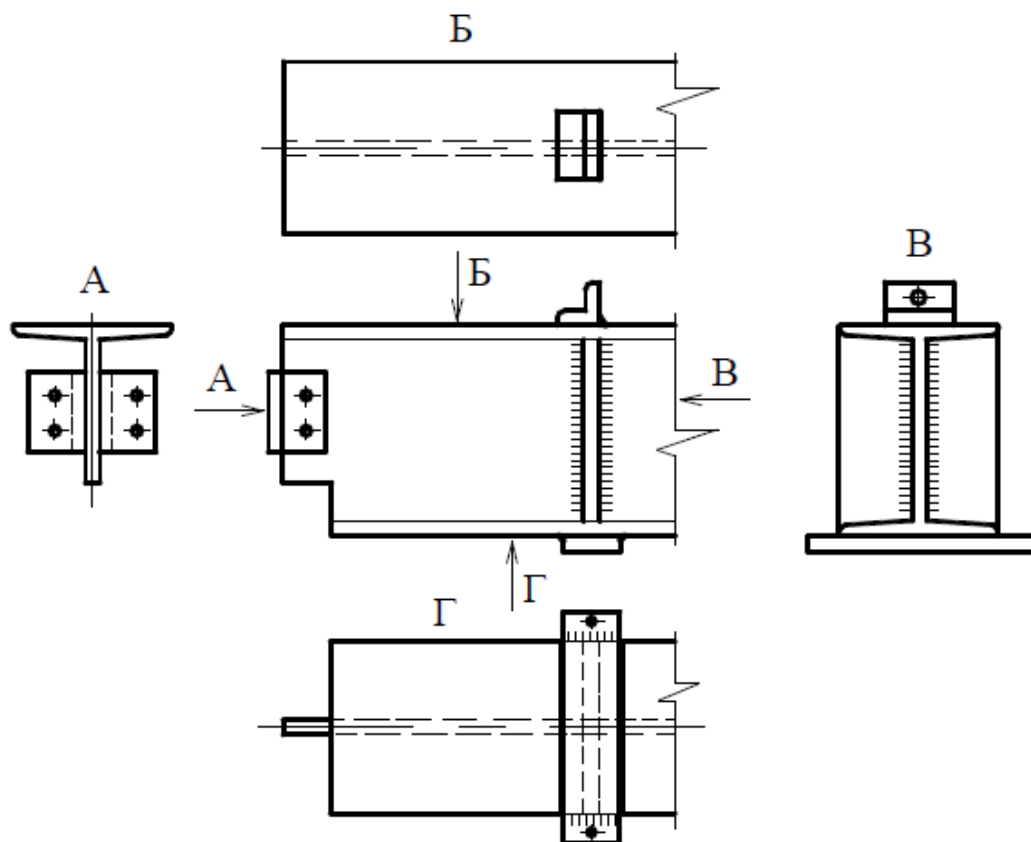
Расположение видов на чертеже металлоконструкций
